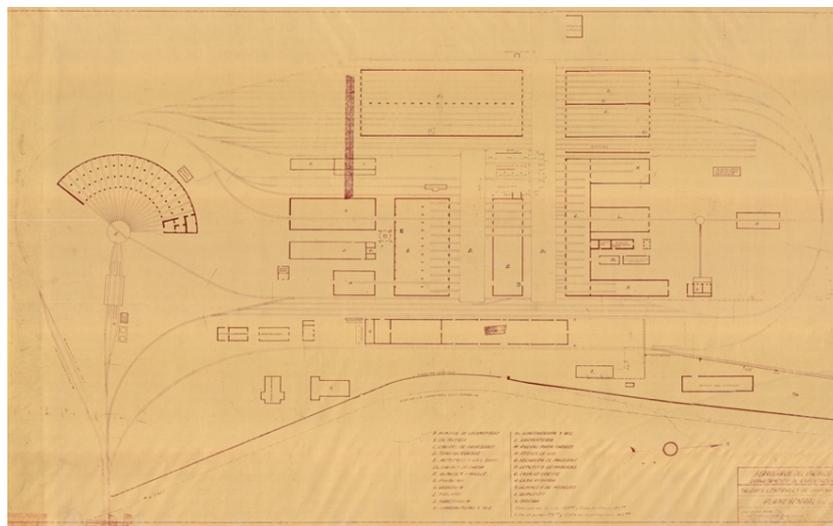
Auteur non identifié, plan « Mise à jour du Plan des ateliers de Chipichape », 1945. Source : Bibliothèque l'Universidad del Valle
